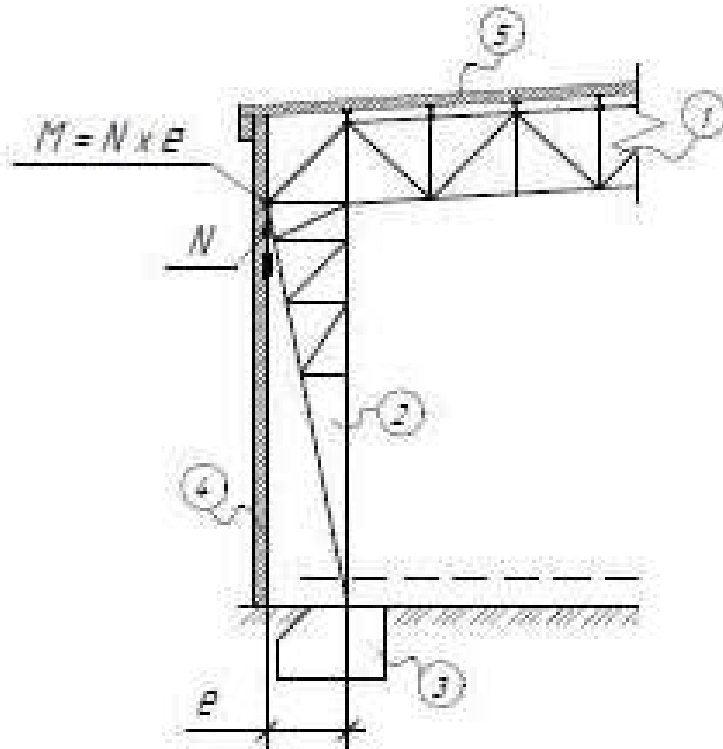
Конструктивный прием разгрузки ригеля рамы от подвешенной наружной стены к верхней части стойки рамы: 1 – ригель рамы; 2 – колонна рамы; 3 – фундаменты под раму; 4 – наружная стена; 5 – кровля с прогонами;  $e$  – эксцентриситет передачи веса с навесной стены на колонну рамы;  $M$  – разгружающий момент;  $N$  – собственный вес подвешенной системы
